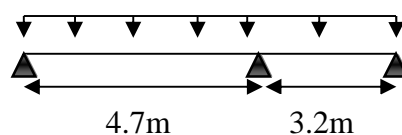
Schéma statique d'une poutrelle d'étage courant type 07
